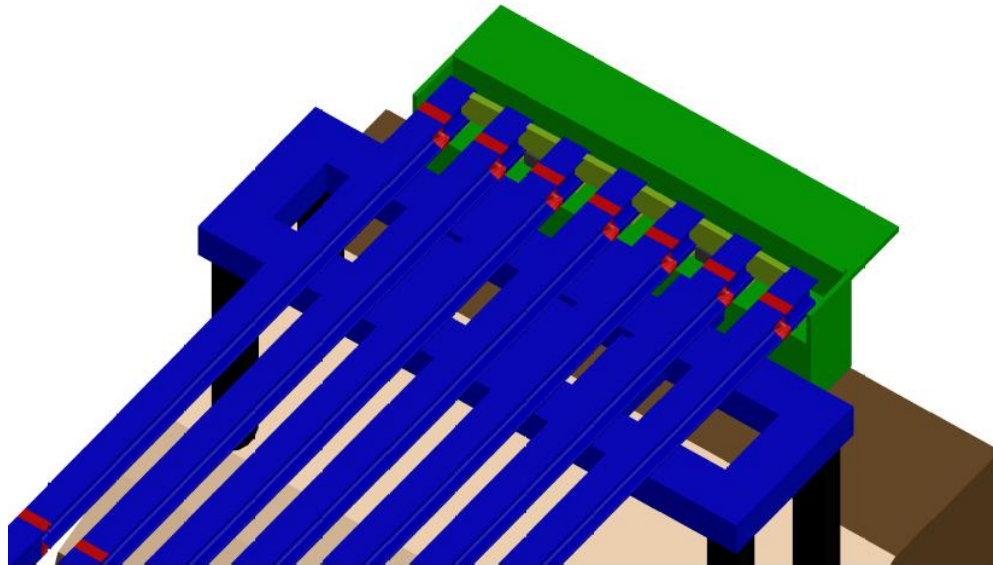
Detalle del apoyo de las traves sobre la estructura auxiliar de apoyo en la margen derecha del puente La Pigua III.
